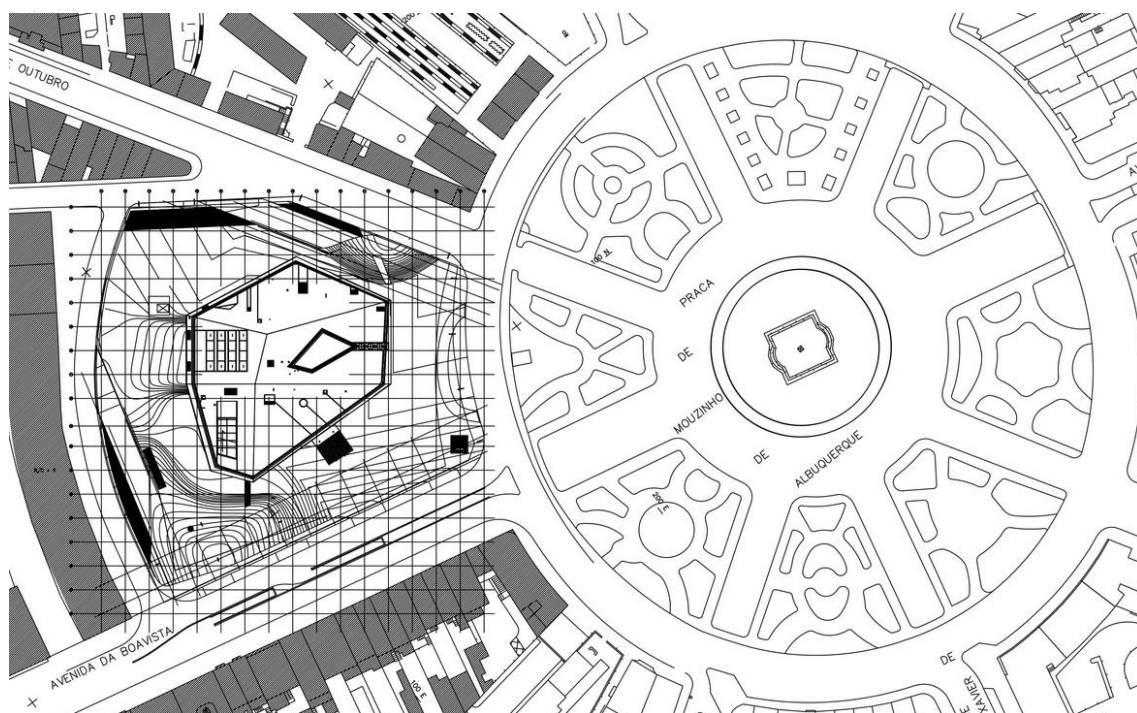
Planta de implantação da Casa da Música, Porto.
